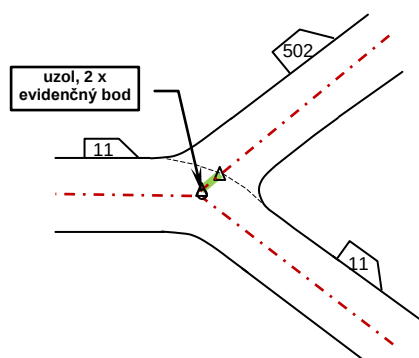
Detail križovatky, šikmé napojenie, stykové, zaraďovací pruh
